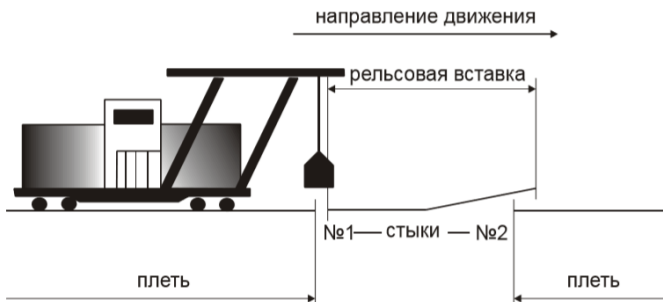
Схема расположения ПРСМ и рельсовой вставки в месте сварки
